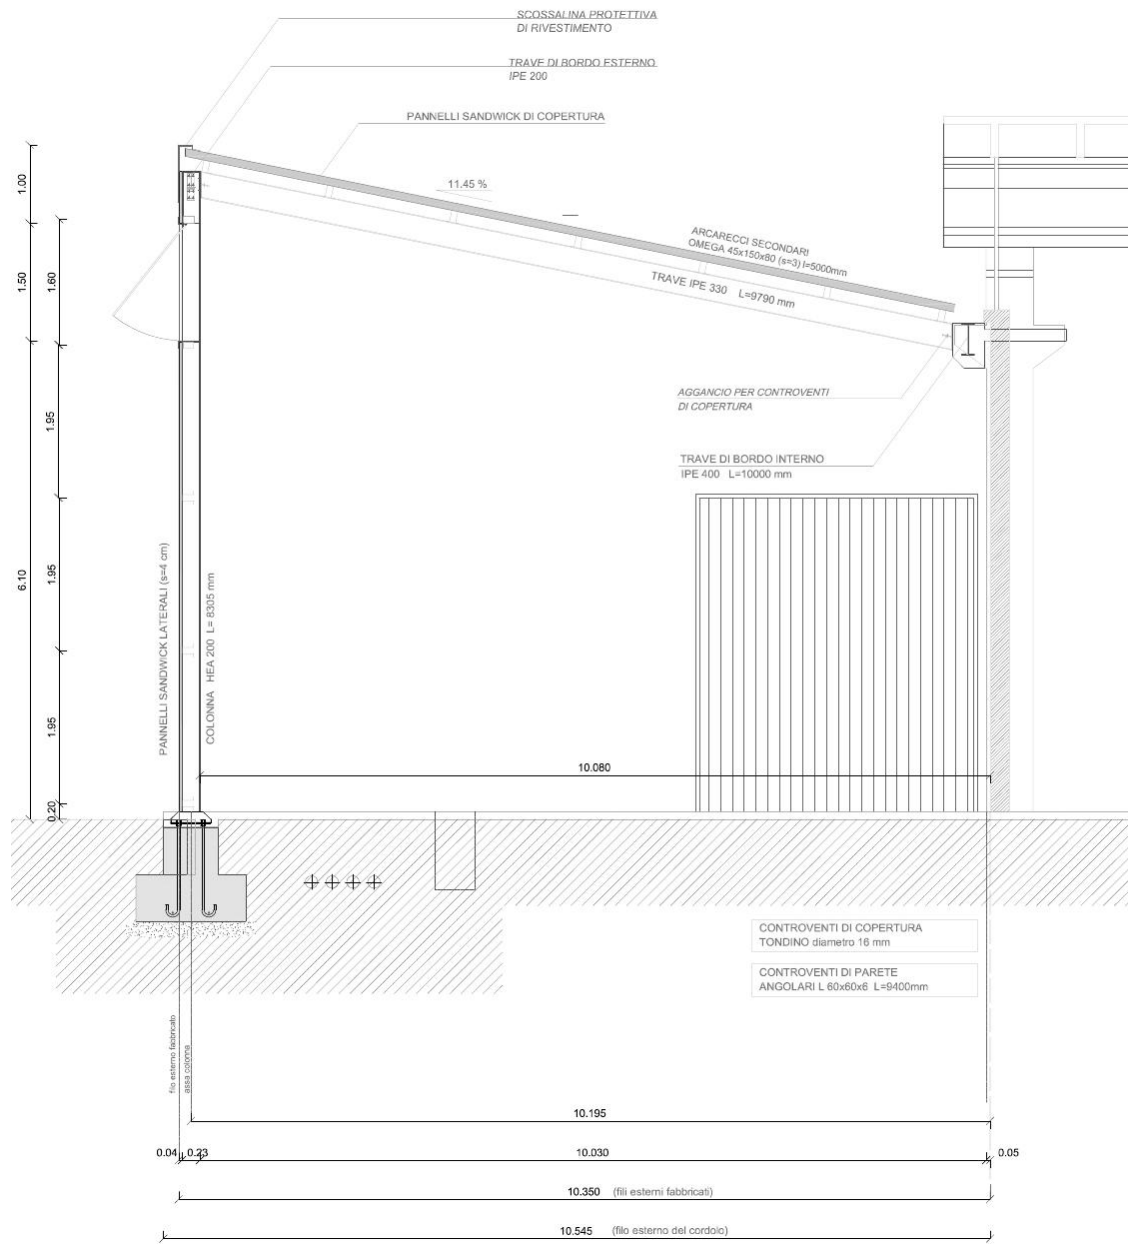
Particolare di A.2001.a.sa.T01 - Fondazioni - Sezione tipo
